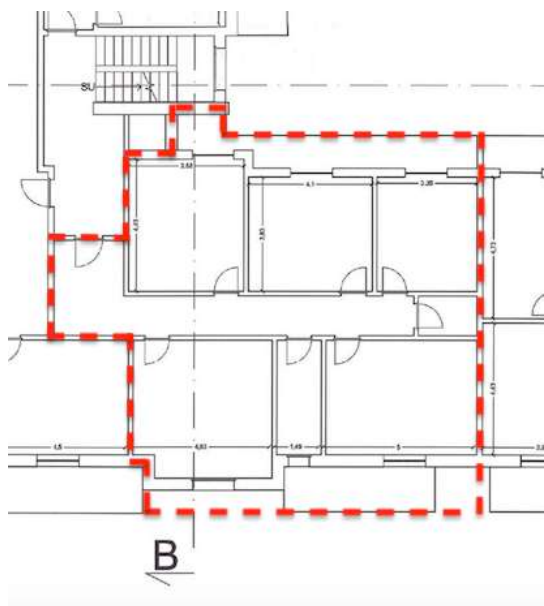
Stralcio Pianta “Piano Tipo” - S.C.I.A. prot. n. 07754/2021
